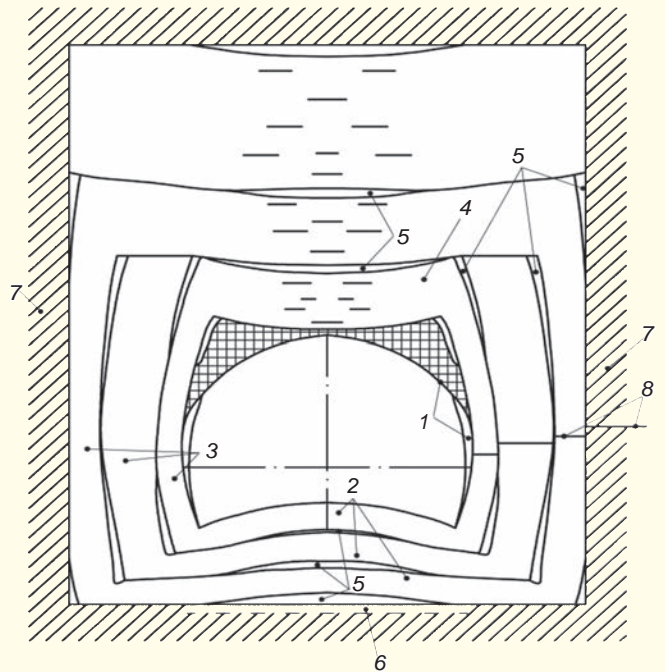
Схема деформирования (разрушения) пород приконтурного слоя и образования зон разрушения: 1 – металлическая арочная податливая крепь; 2 – деформированные породы подошвы выработки; 3 – деформированные боковые породы; 4 – деформированные породы кровли; 5 – пустоты и трещины в деформированных (разрушенных) породах приконтурного слоя; 6 – вода; 7 – ненарушенный массив вмещающих пород; 8 – маркирующий слой.
